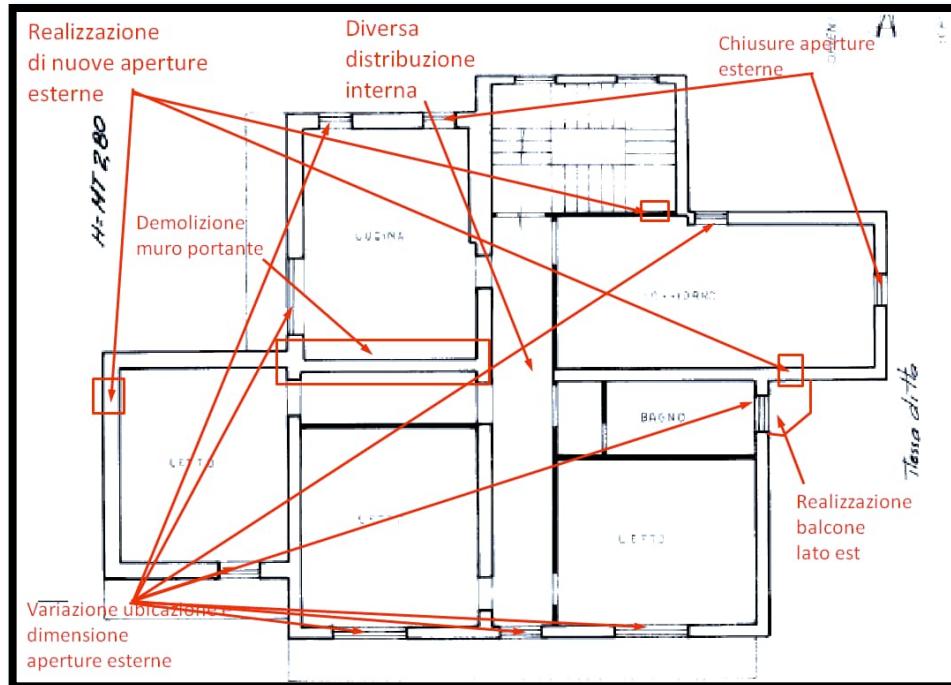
Pianta piano secondo allegata alla C.E. n.34/1981 - Rappresentazione difformità strutturali
